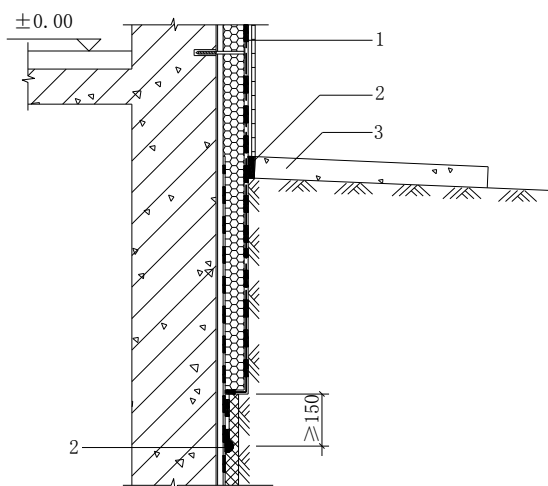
上部结构与地下墙体交接部位防水防护构造
